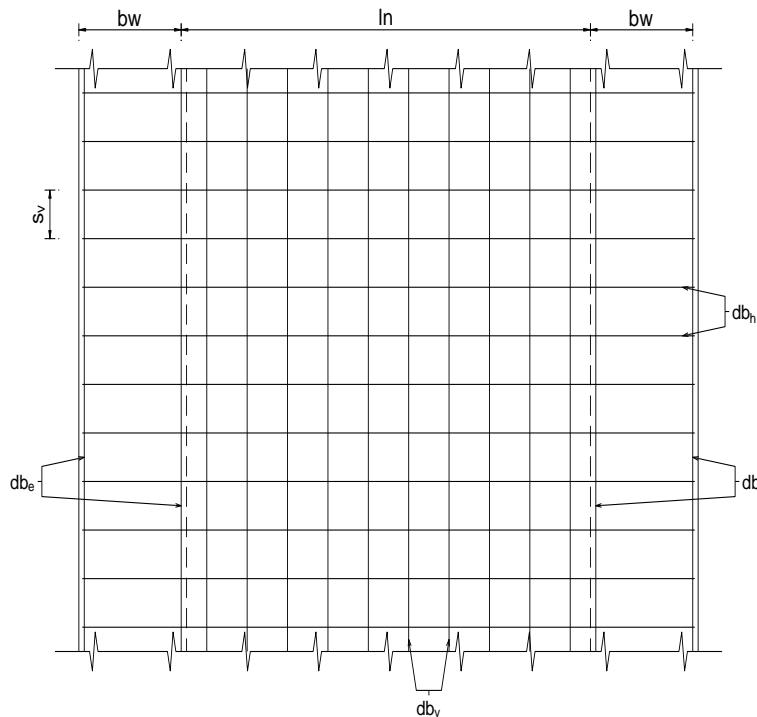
Muros de cortante, vista en sección, nomenclatura
